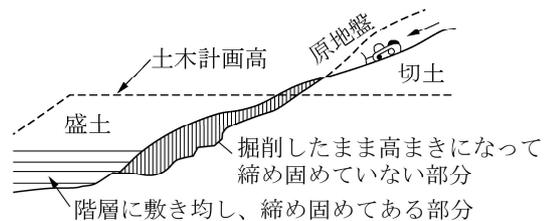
切土・盛土の接続部にありがちな施工状態
